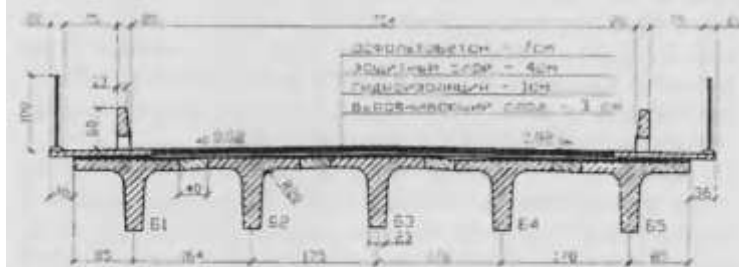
Поперечное сечение пролетного строения со стеклопластбетонными балками
